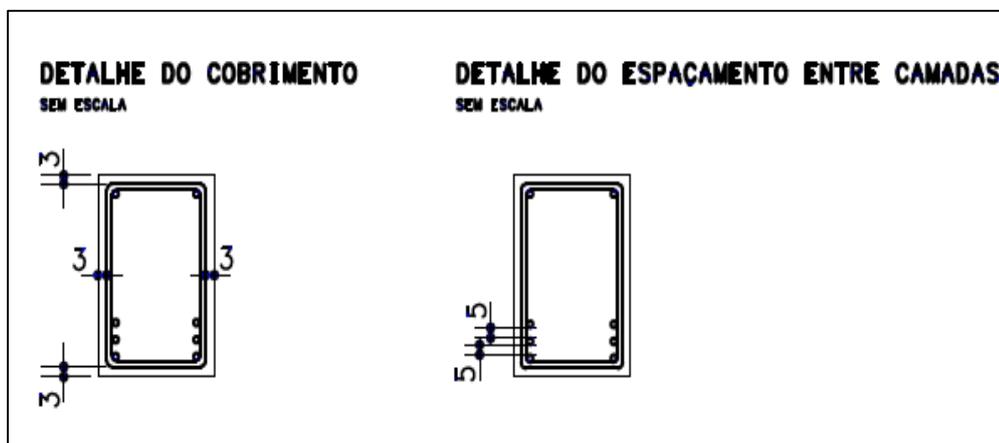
Detalhe do cobrimento e espaçamento entre camadas para viga V320. Fonte: Contrutora Reynold (2018).
